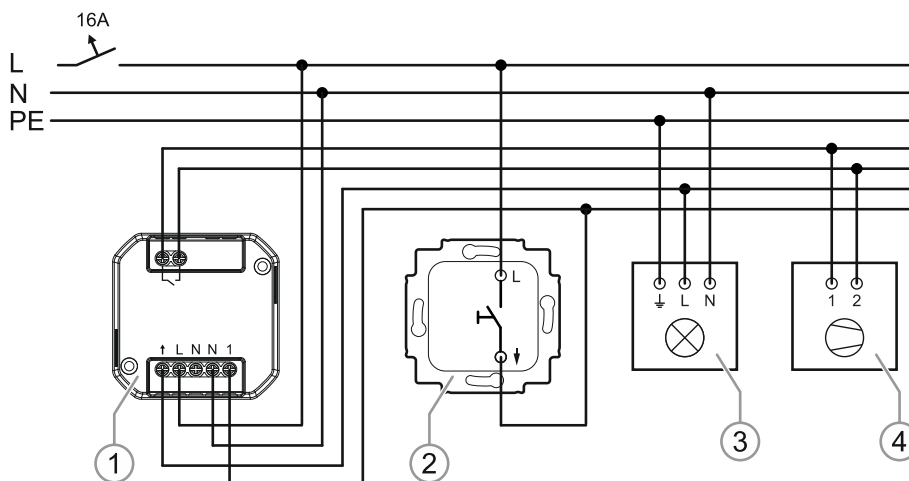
Beispiel-Schaltplan: Kleines Büro mit Licht- und HLK-Steuerung
